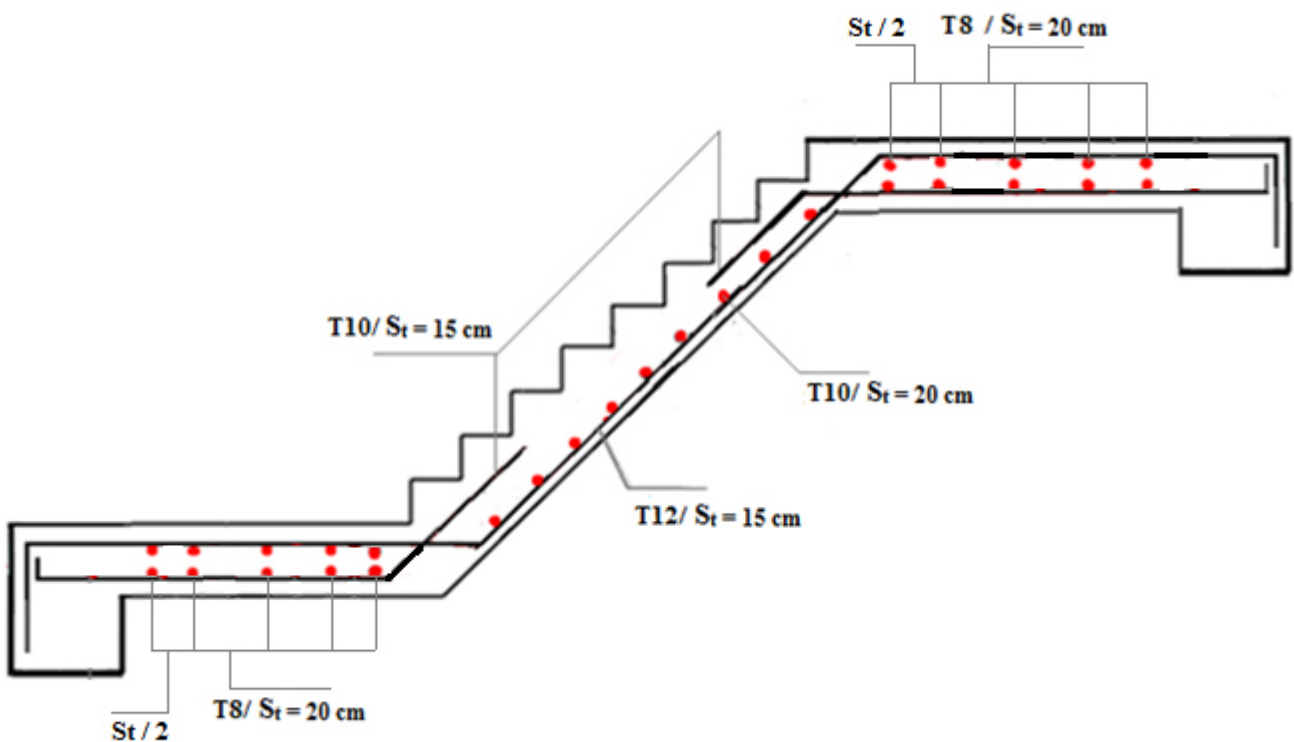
Schéma de ferrailage de l'escalier de RDC.
